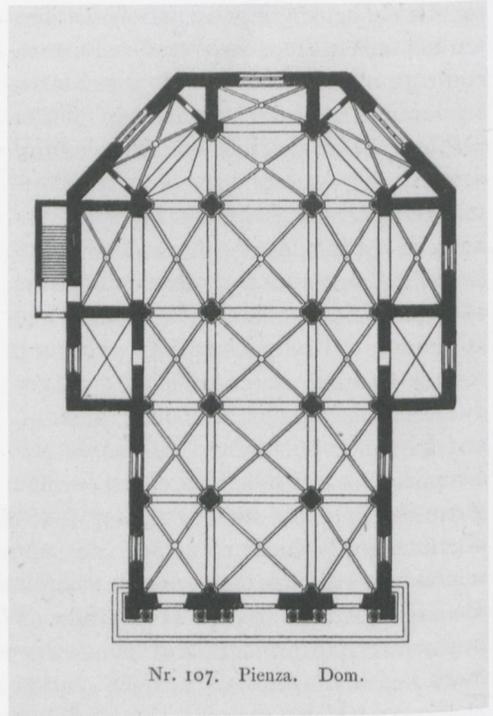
Pienza, Kathedrale, Grundriss
